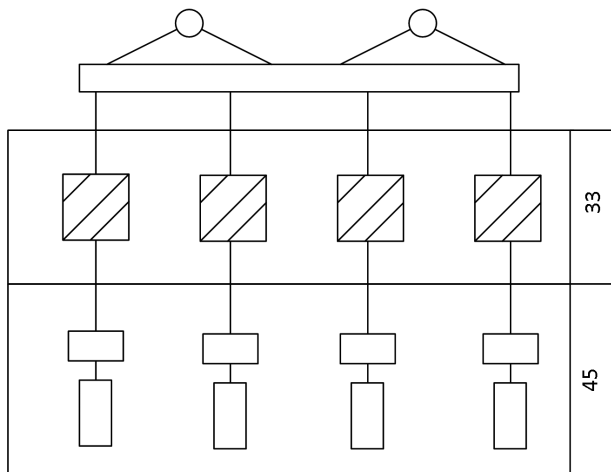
Компоновка главного корпуса ТЭС с поперечным расположением
